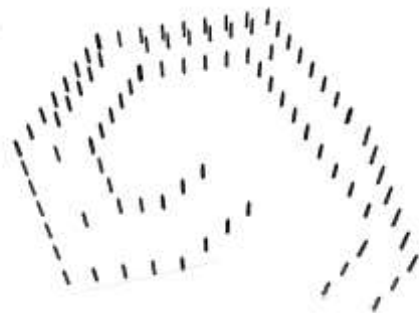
Sistem struktur rangka konstruksi beton.
